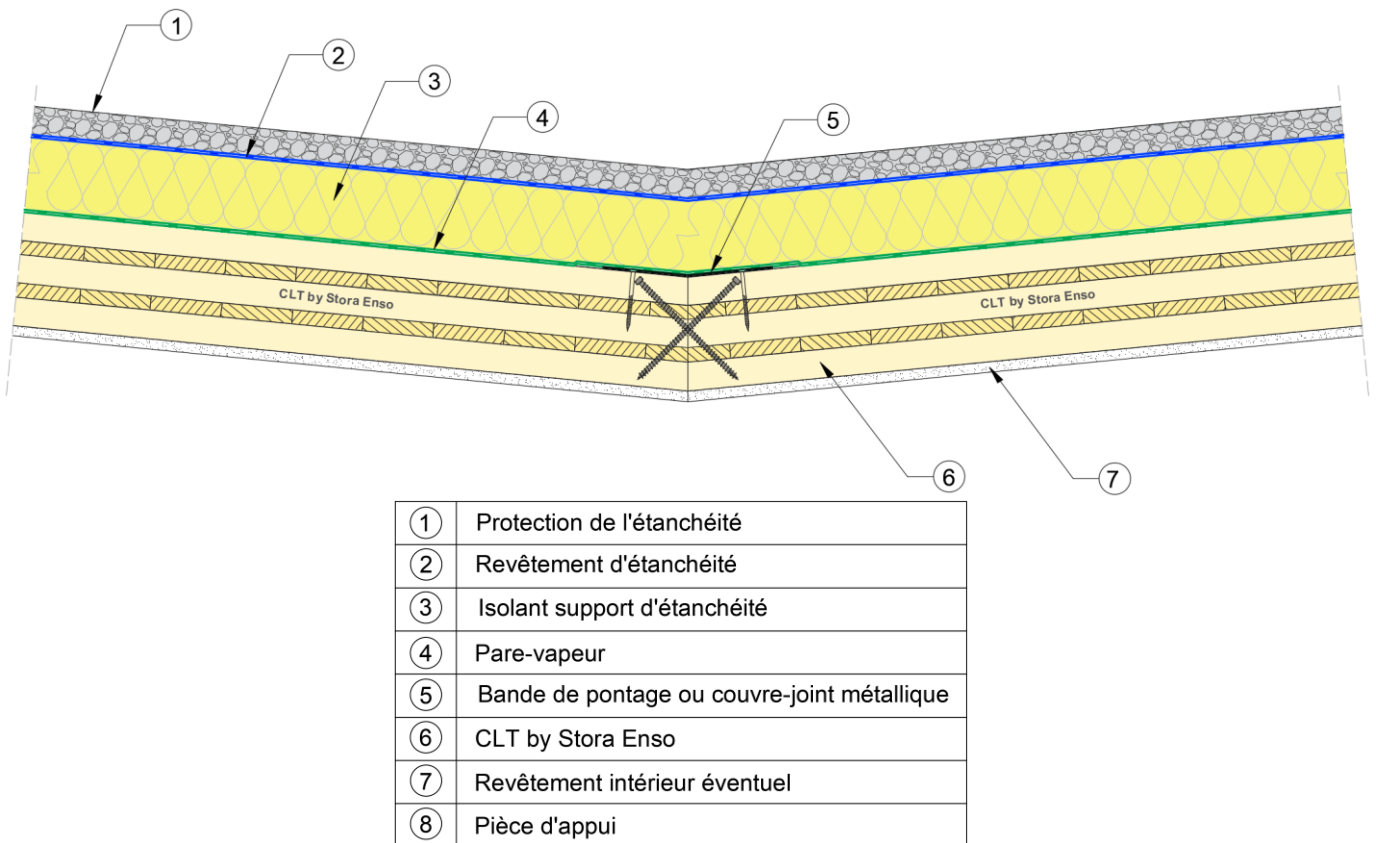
Toiture chaude isolée inaccessible – Noue centrale non appuyée
